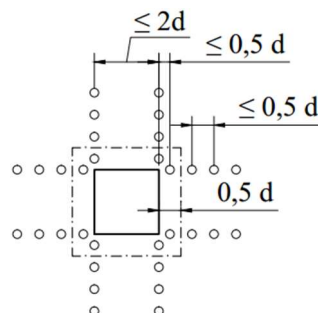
Especificações para posicionamento em planta da armadura de cisalhamento segundo o ACI 318
